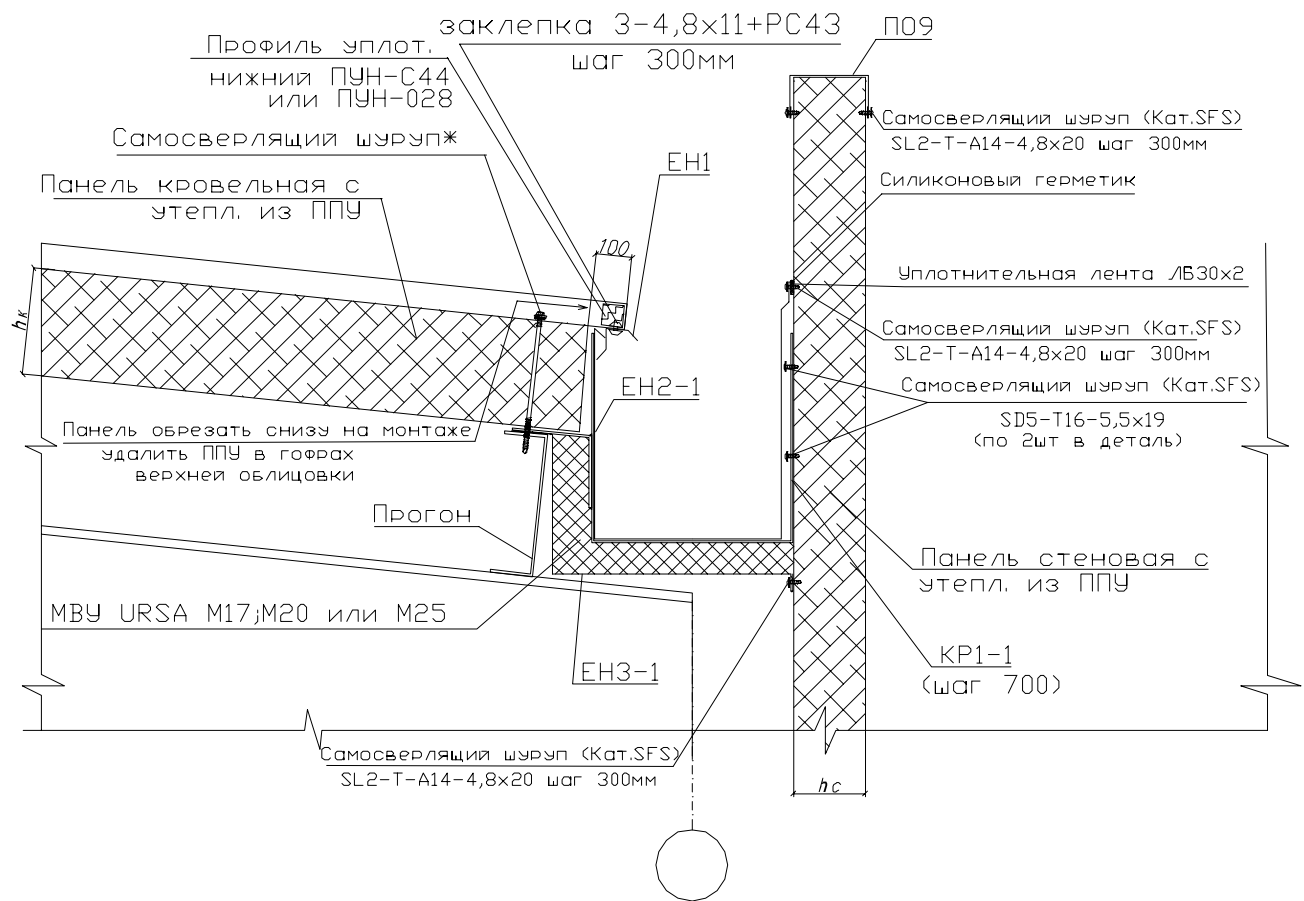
Внутренний водослив с несущим желобом (примыкание кровли к стене)
